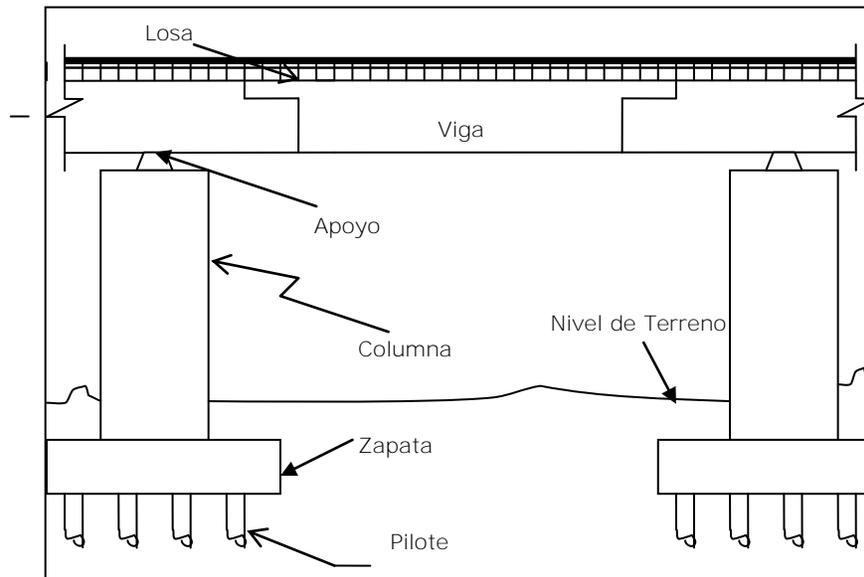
Elementos que forman la subestructura y superestructura de un puente.
